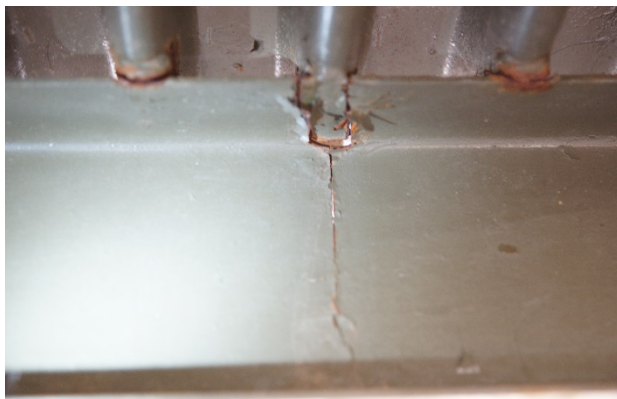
а, в. дальнейшее развитие трещины до перелома продольной балки
